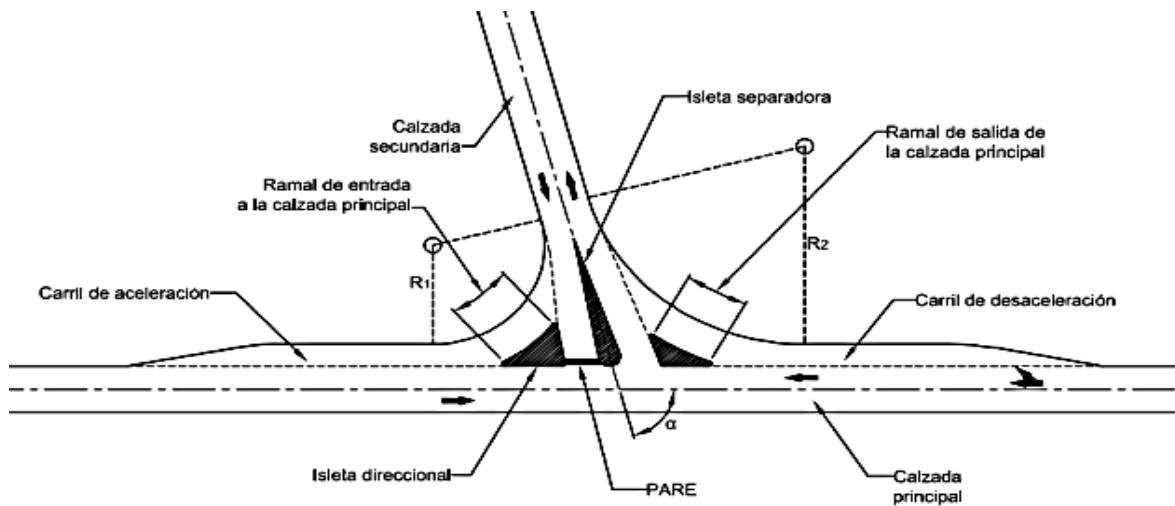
A.204- 09 Esquema base intersección en “T”o”Y” con separador y carril de giro a la izquierda
